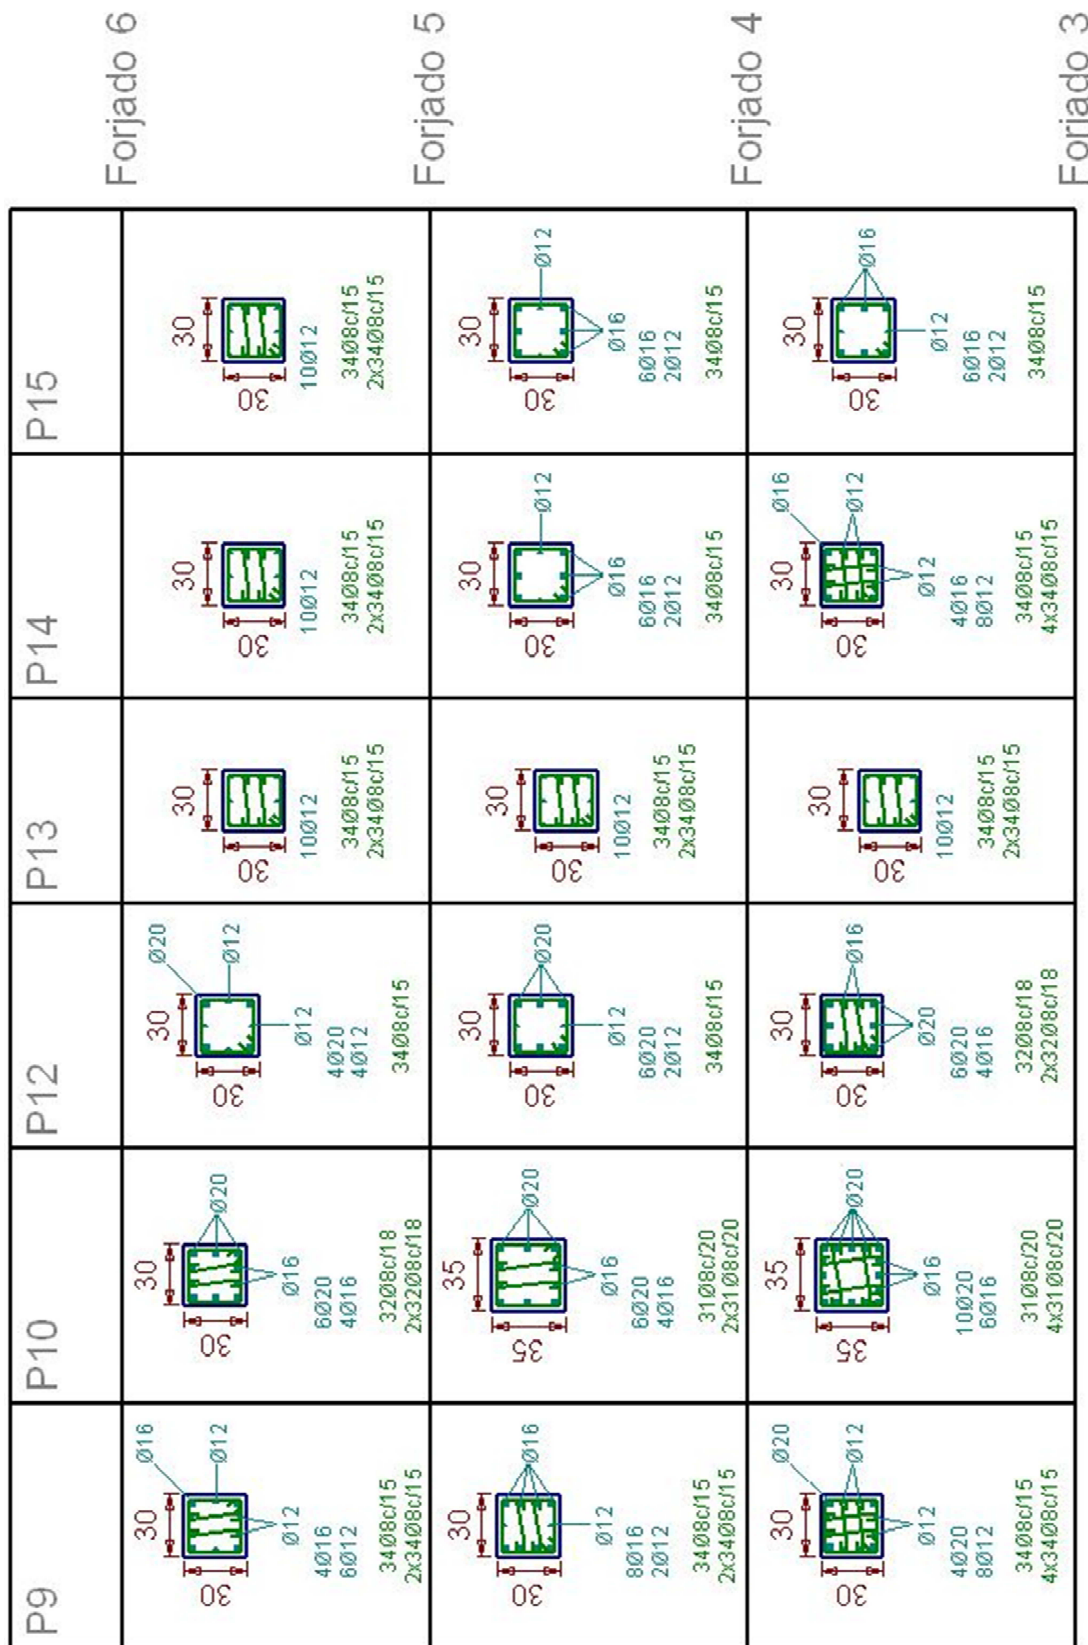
Armadura en pilares (3). Edificio de 9 plantas (SISMO + G).
